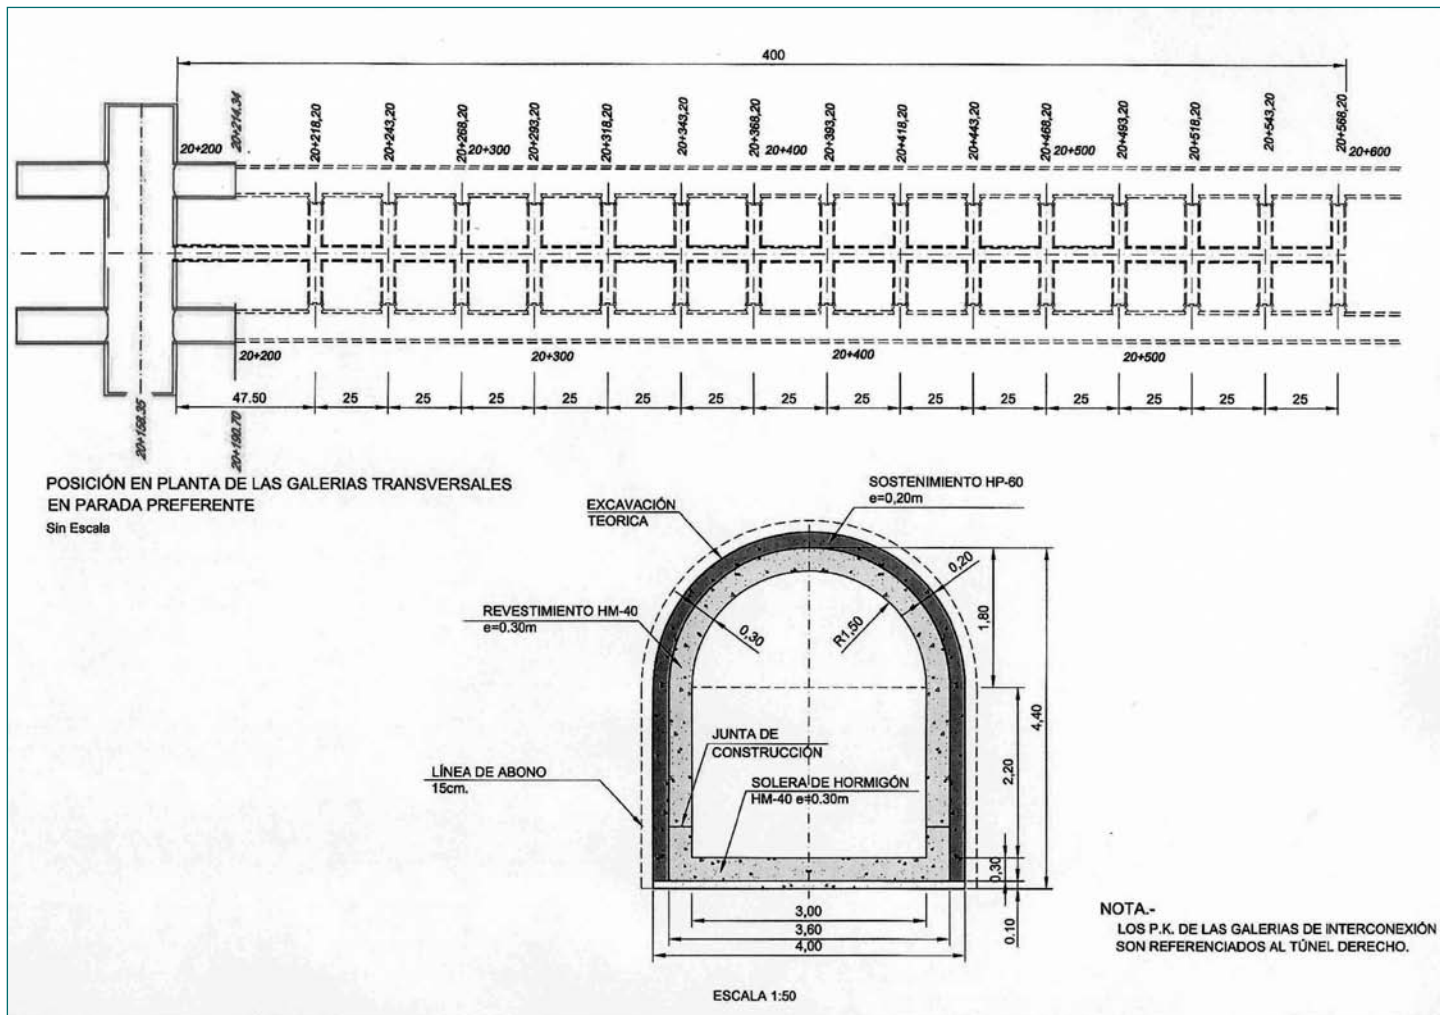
Plano de planta de la parada preferente/Plan and section of the preferential stop.
